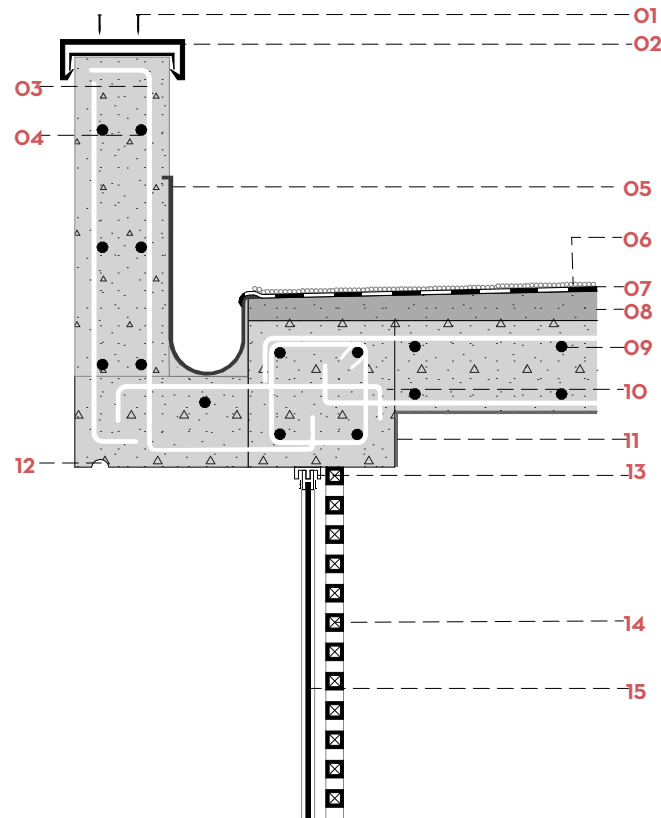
Detalle constructivo O5. Fuente: Autoría propia.
